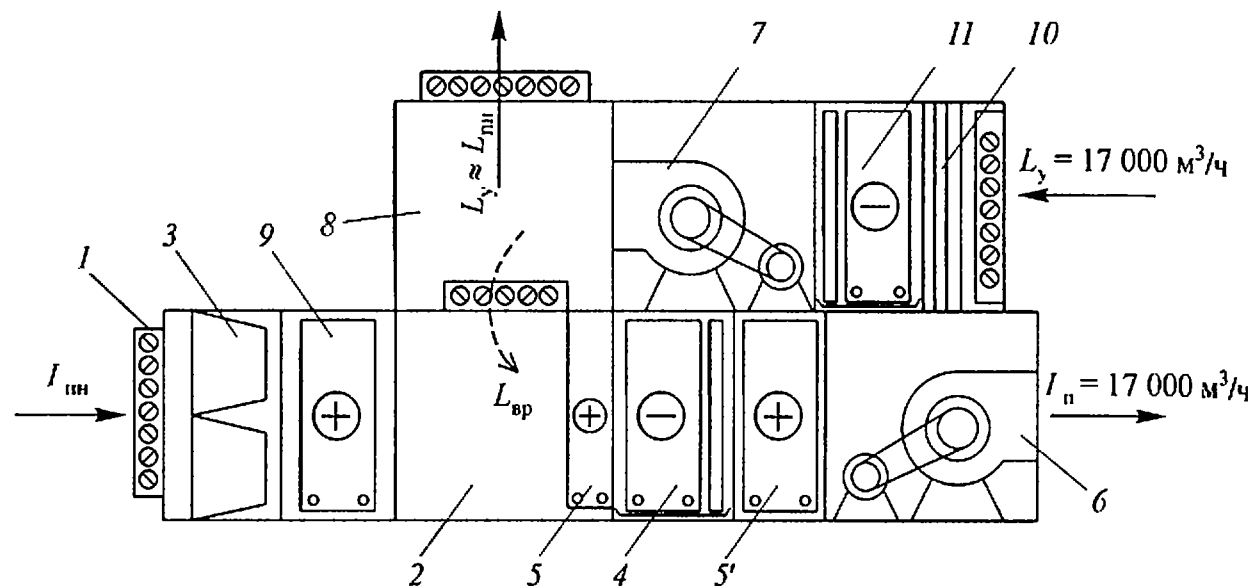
Принципиальная схема приточно-вытяжного агрегата для СКВ обслуживания ледяного поля или арены со зрителями и сценой: 1 — клапан забора наружного воздуха; 2 — смесительная камера; 3 — карманный фильтр; 4 — воздухоохладитель с сепаратором; 5 — калорифер; 6 — приточный вентилятор; 7 — вытяжной вентилятор; 8 — камера разделения рециркуляционного $L_{вр}$ и выбросного L_y воздуха; 9 — теплоотдающий теплообменник установки утилизации теплоты вытяжного воздуха; 10 — фильтр; 11 — теплоизвлекающий теплообменник установки утилизации с насосной циркуляцией антифриза
